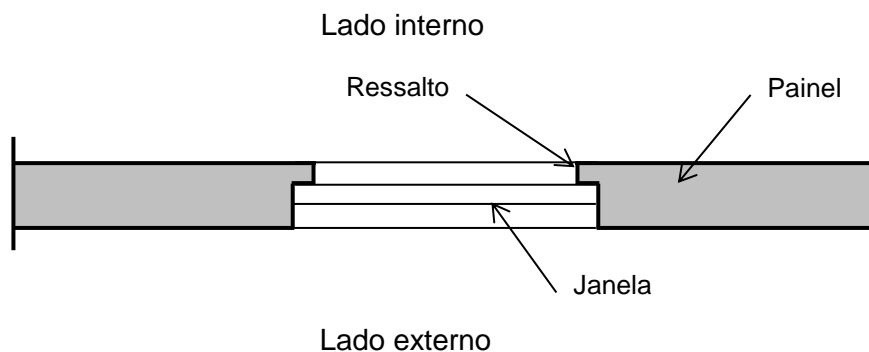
Detalhe da interface entre o painel e a janela na fachada (sem escala)
